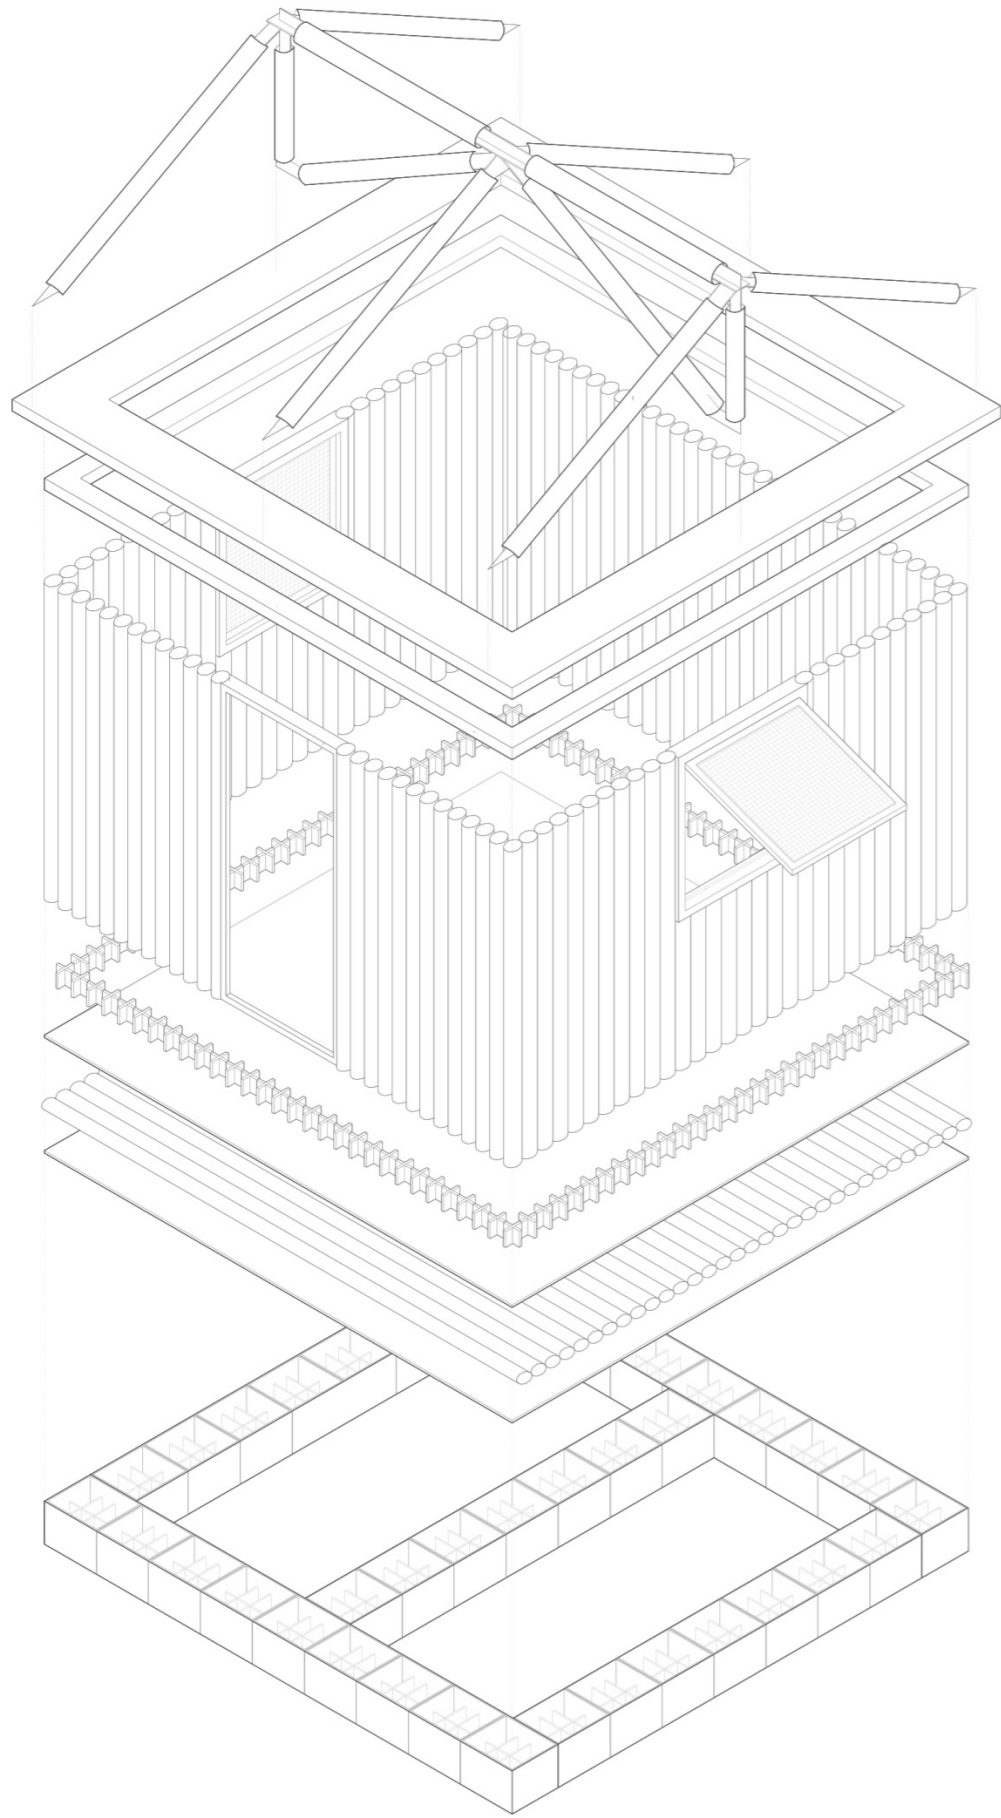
Axonometría estructural Paper Log House. E:1/50. Elaboración propia.
